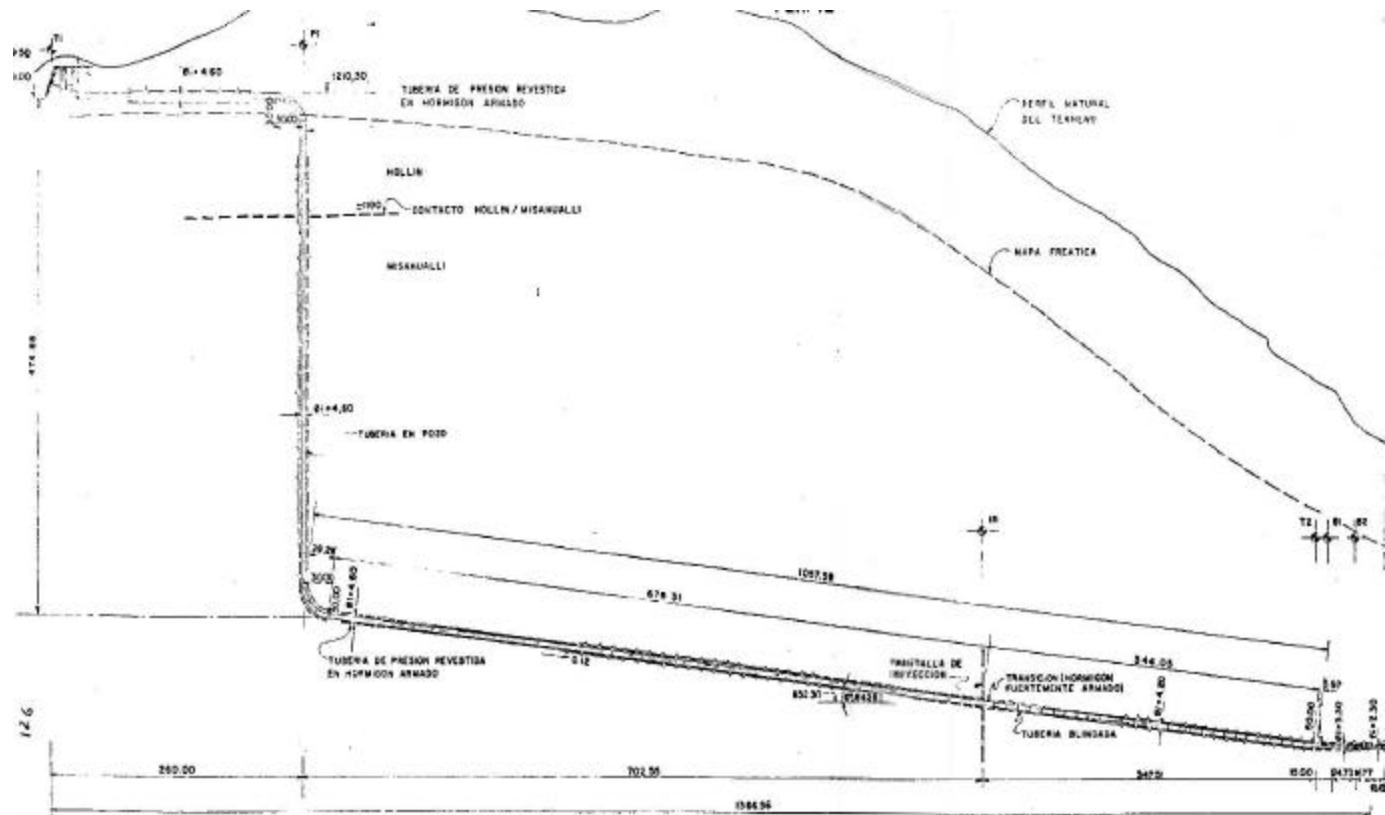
Corte longitudinal de la tubería de presión.
